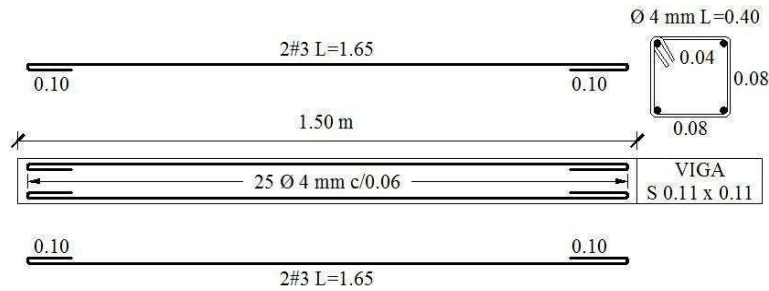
Geometría de las vigas y detalle del refuerzo utilizado
